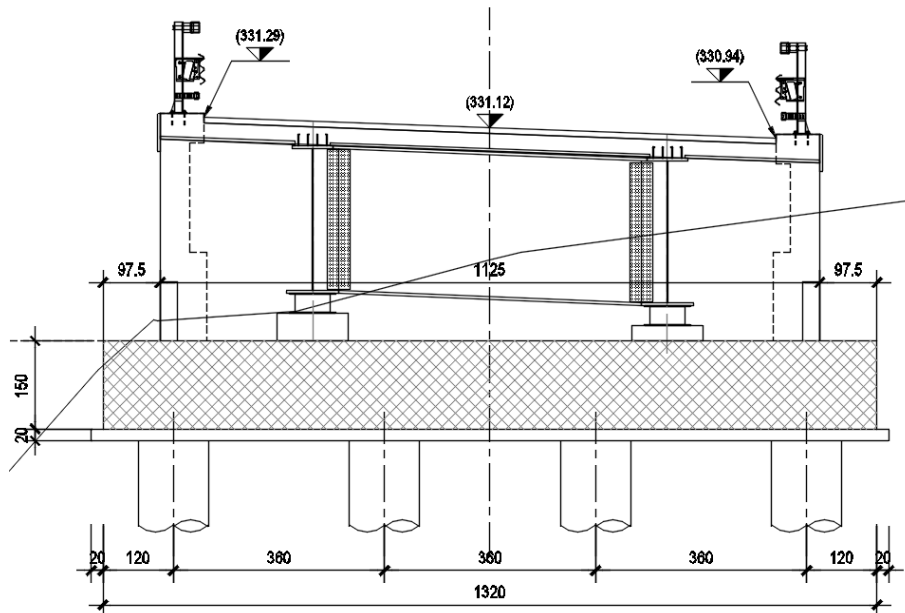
Viadotto Eremita – sezione su spalla.
